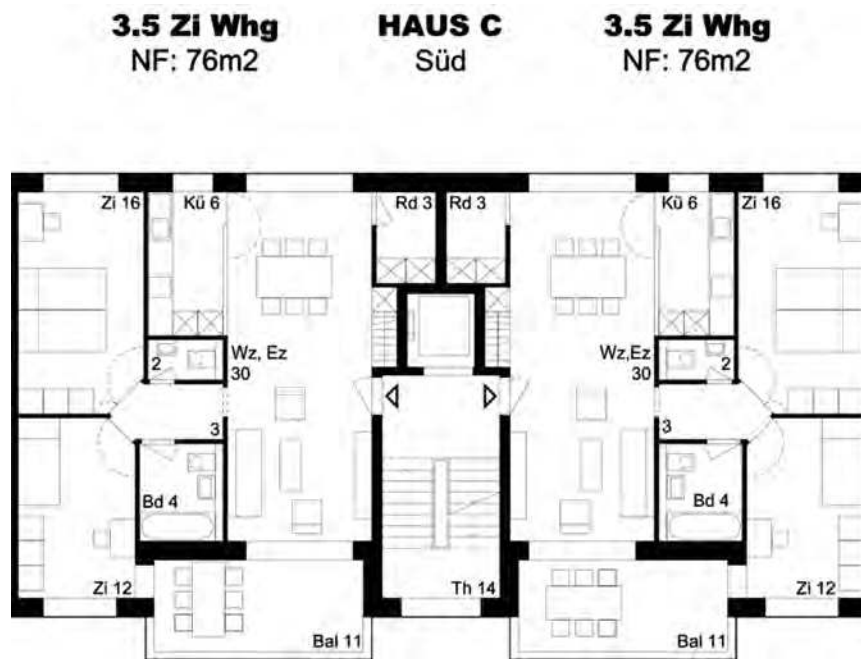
Drei Höfe: Wohnungsgrundriss Haus C Süd, 3.5-Zimmer-Whg.
